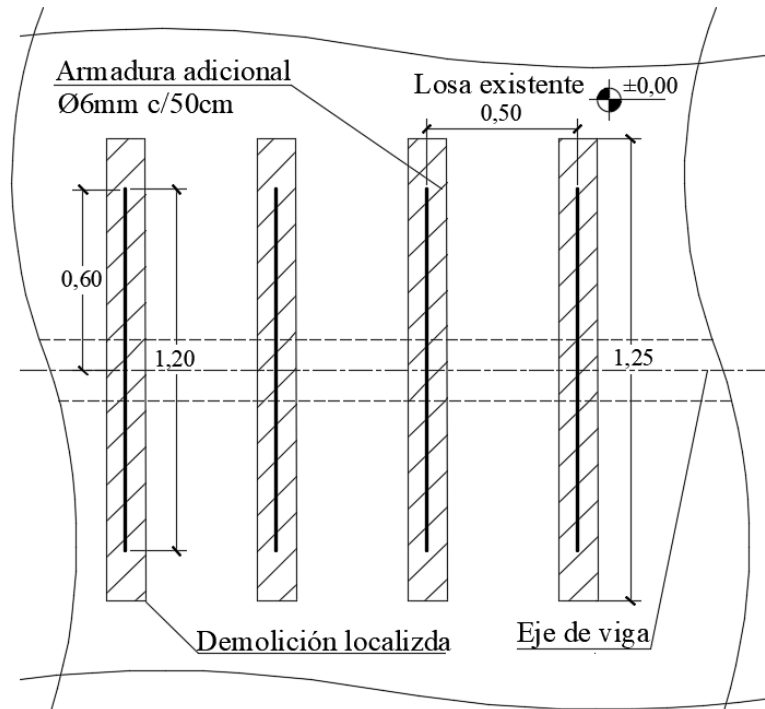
Armadura adicional Apoyo Losas L2/L7.
